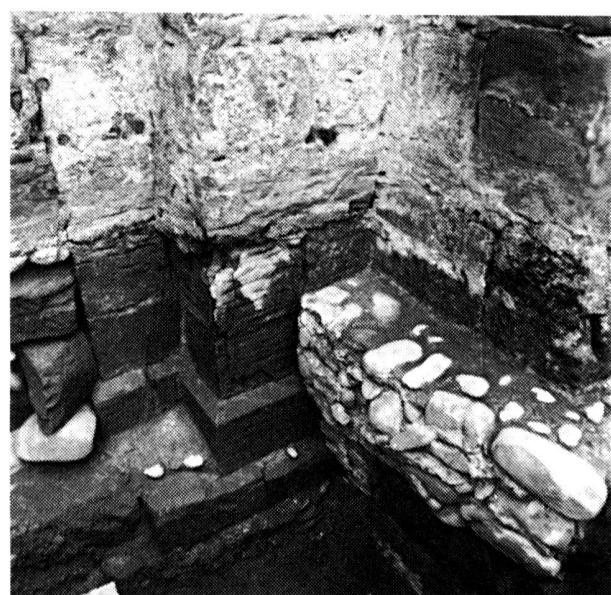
Photographie de la base du pilier visible dans la façade ouest.
